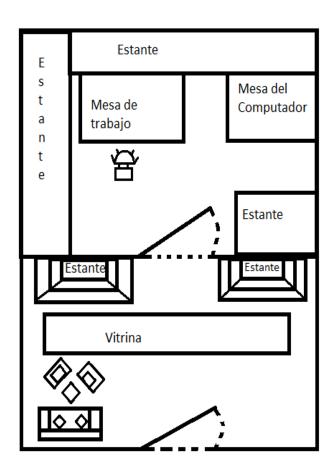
distribuciones de la planta 6.2.8 Planta de personal.
